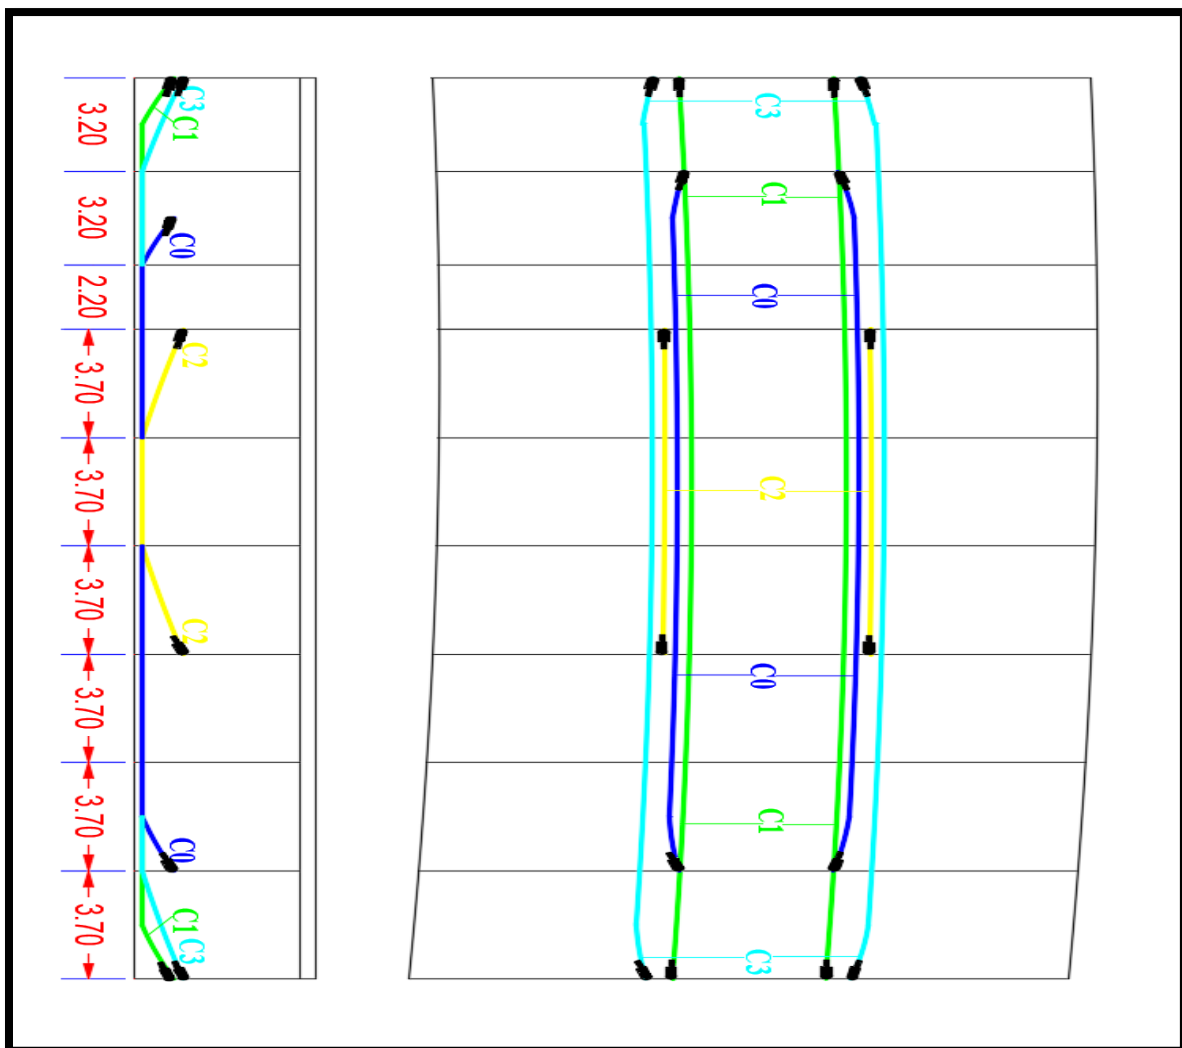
Tracée en plan et élévation des câbles de continuité de travée de rive .
